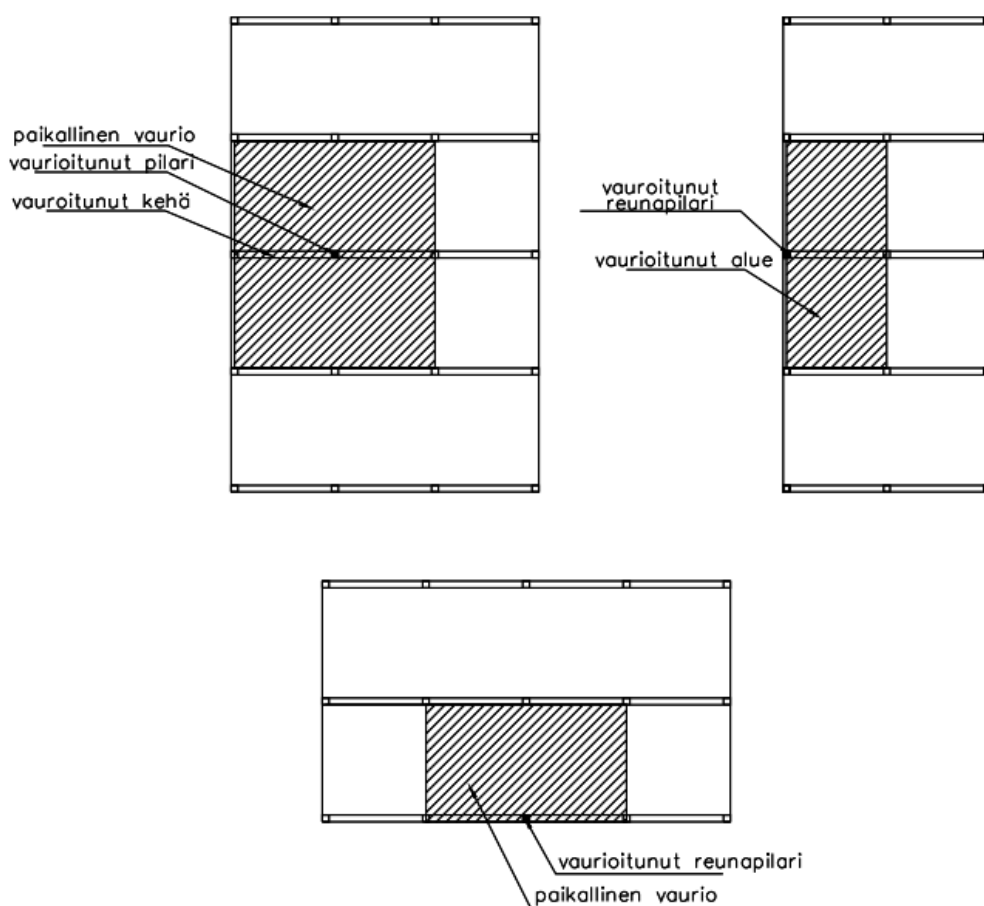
Den högsta tillåtna area som får kollapsa. Källa: Elementtisuunnittelu.fi
